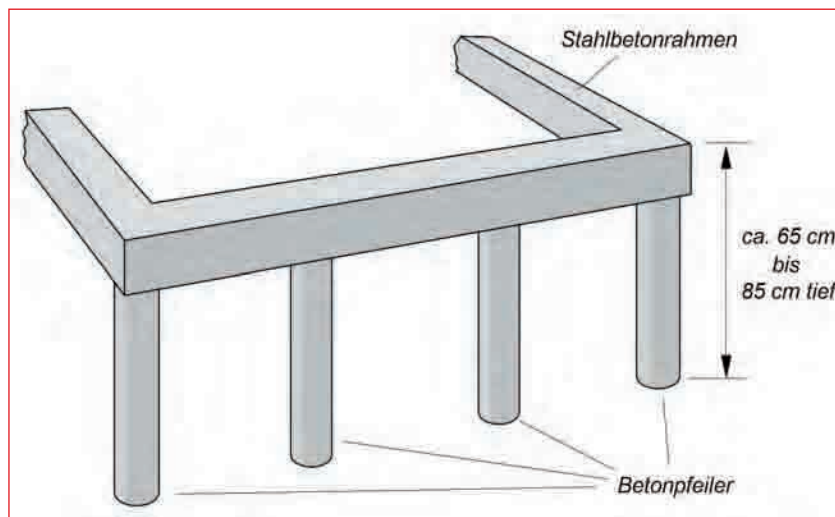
Einfache Betonfundamente für Geräteschuppen und ähnliche kleine Objekte im Garten.
